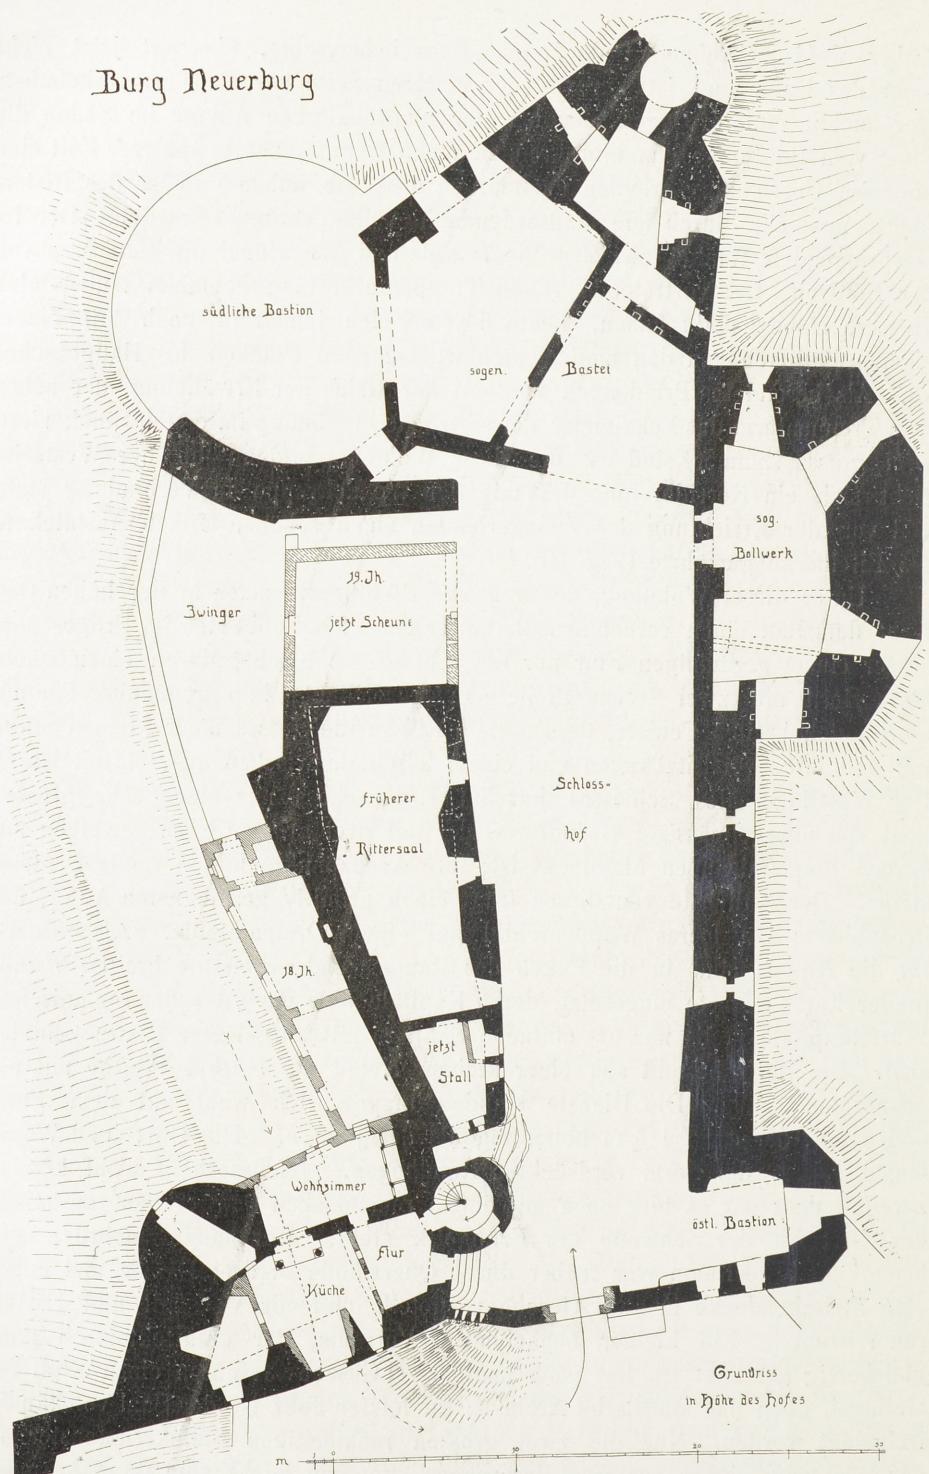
Schloss Neuerburg. Grundriss in Höhe des Hofes.
